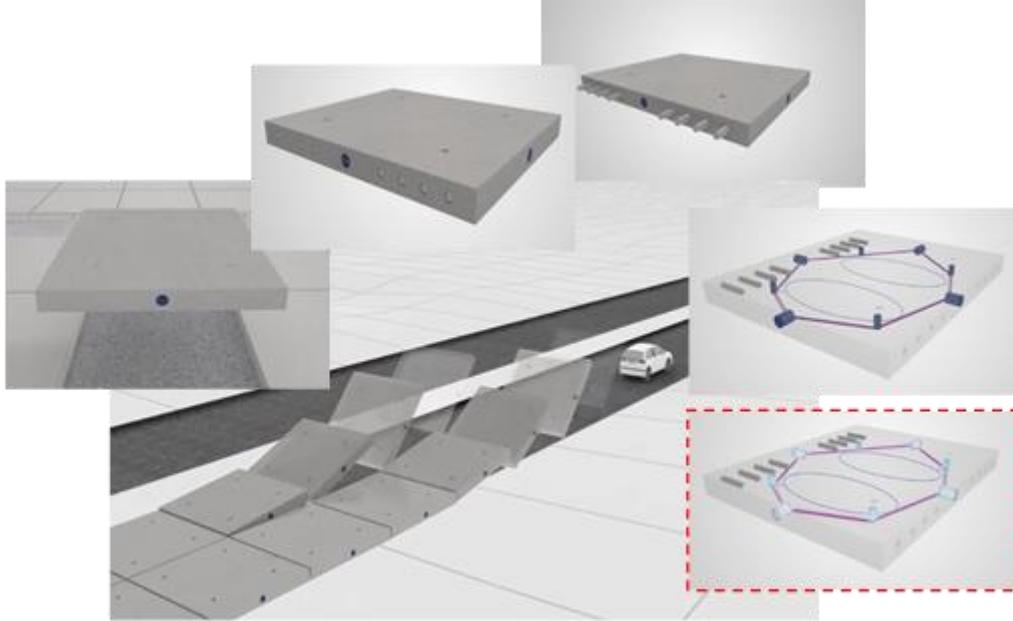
، يوضح نموذج مقترح ثلاثي الأبعاد للتصميم الداخلي للسيارات التي تعمل بال شحن الذاتي داخل الجسر الذكي - Smart Pavement Bridge
